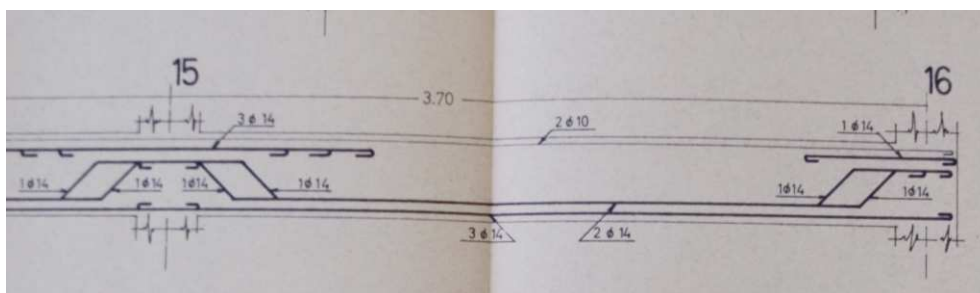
Despiece de viga. Edificio ficha 197C.011, 1966.
